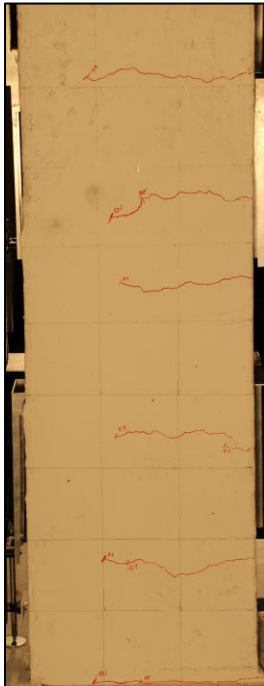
Fissuration horizontale de la colonne C1A au LS1
